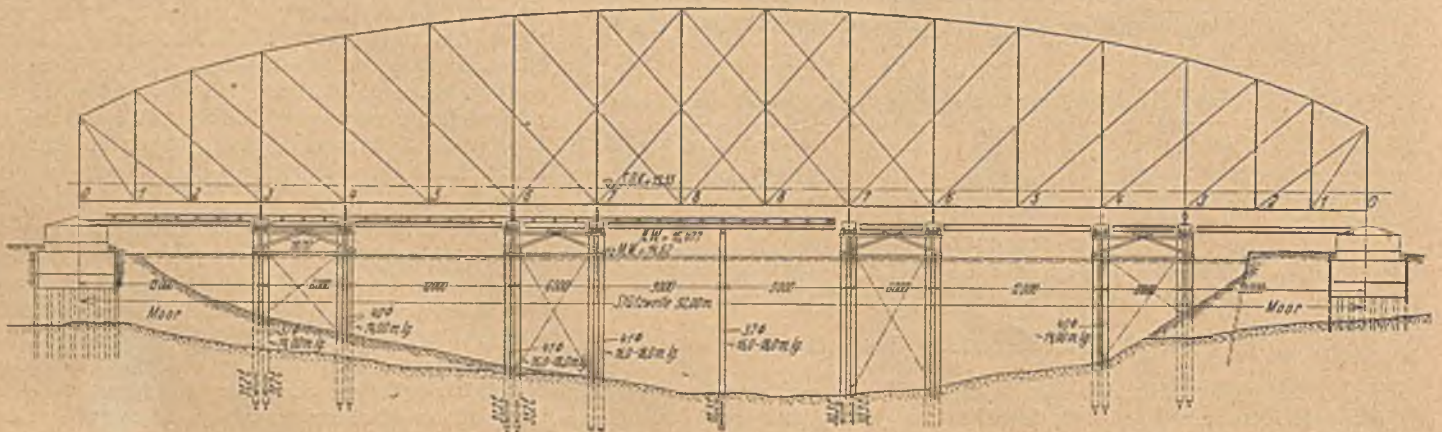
Zeggelinstrombrücke, Montagegerüst.
